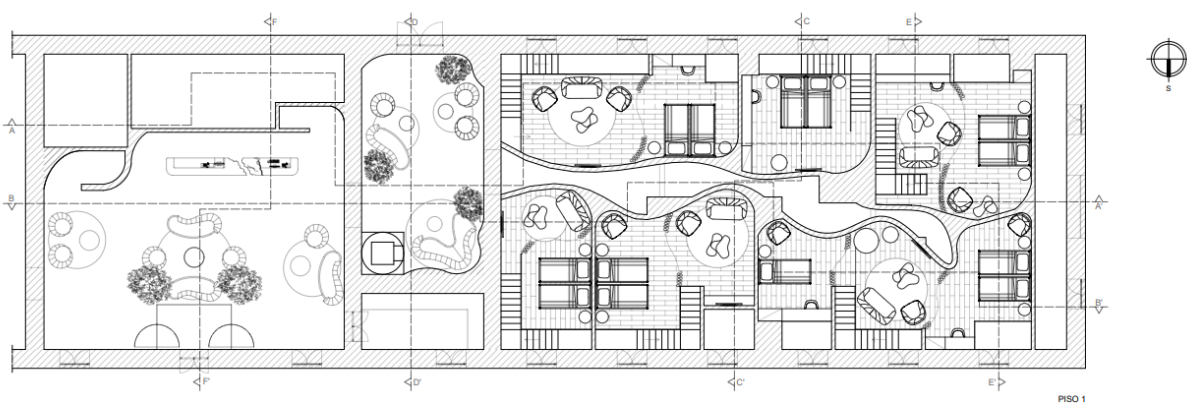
I - Planta de Apresentação, Piso 1, Alojamento Olive
